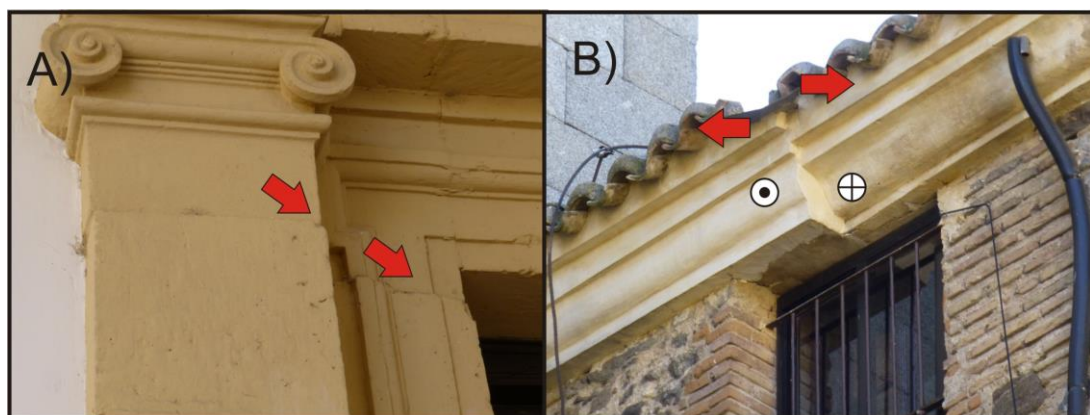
Desplazamiento horizontal de bloques de sillería: A) puertas NE del segundo piso del claustro; B) desplazamiento en el alero del muro exterior de dirección N128°E.
